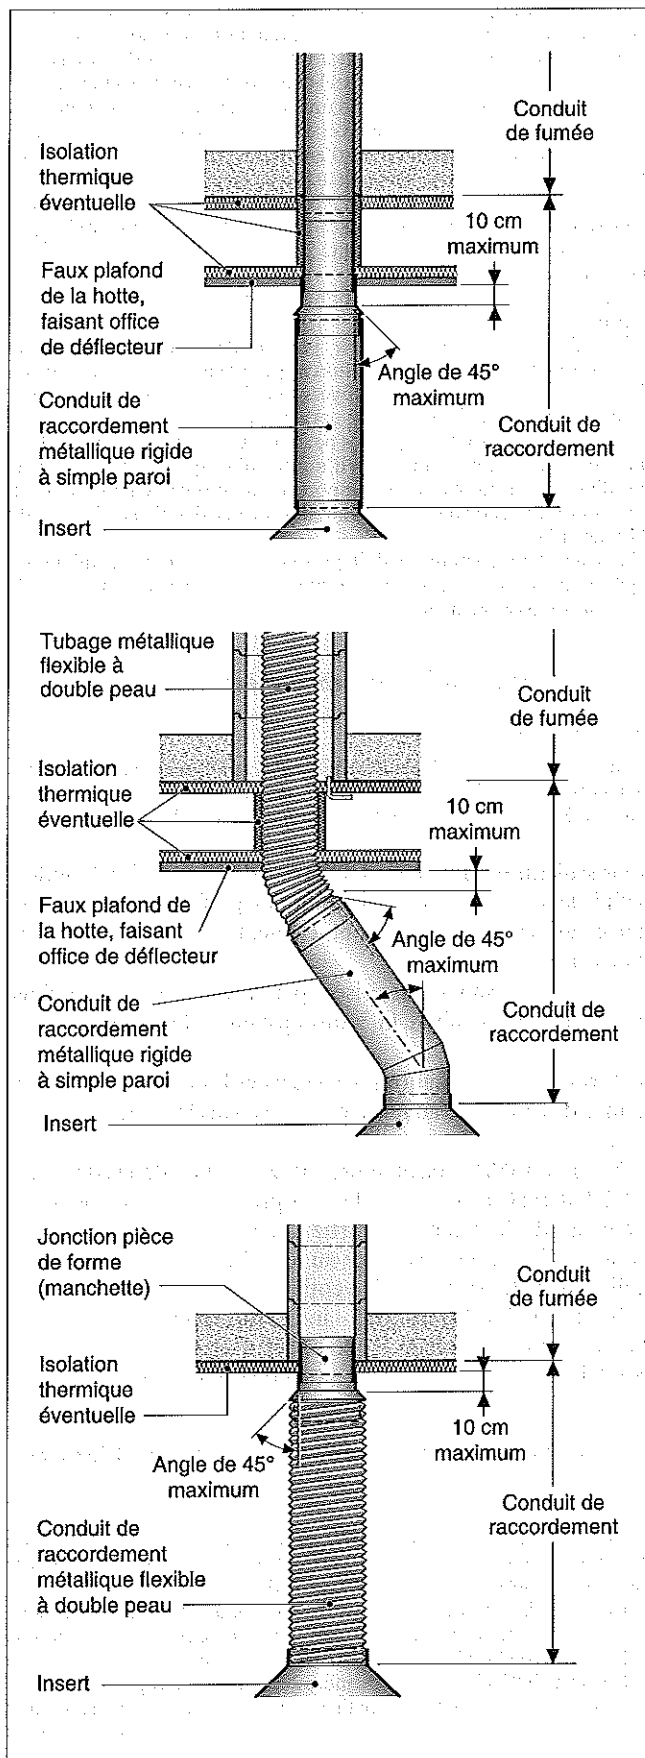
Exemples d'une variation de section sur un conduit de raccordement (source : d'après le DTU 24.2 P1-1).
